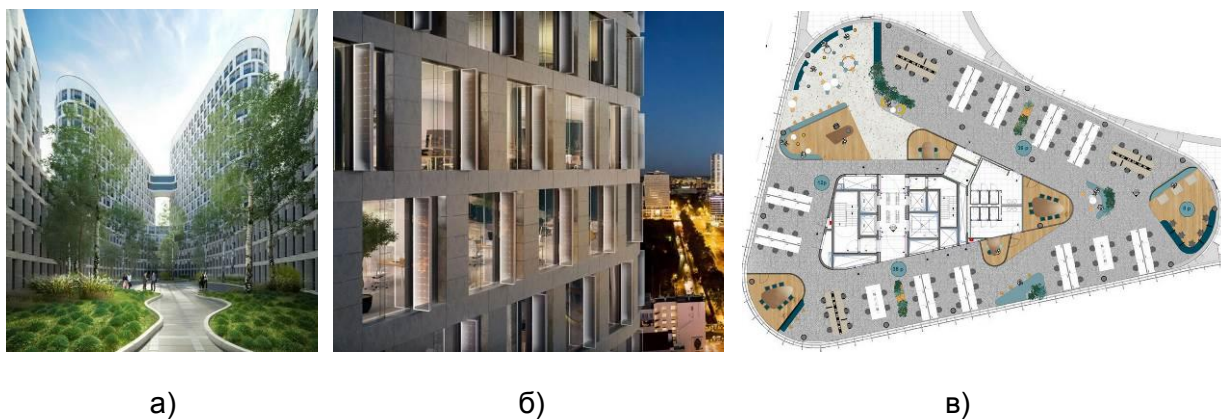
Инженерно-конструктивные решения офисного комплекса «Quatuor-Building»: а) общий вид на внутренний двор; б); фрагмент фасадного решения; в) план четвёртого этажа
